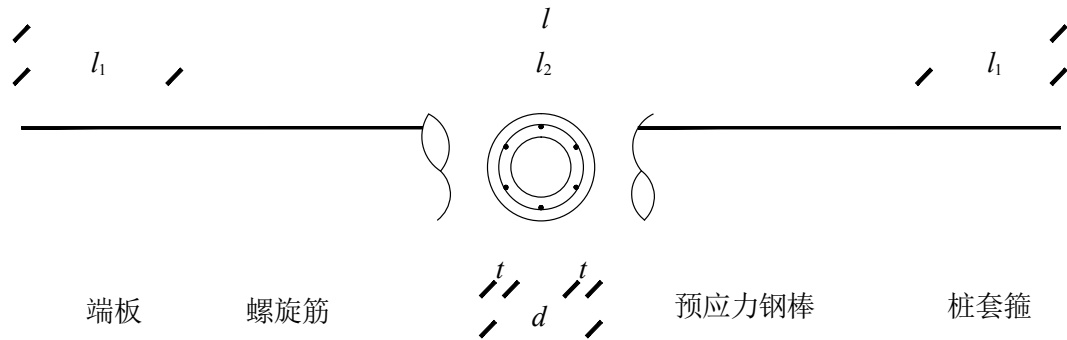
预应力超高强混凝土管桩、预应力高强混凝土管桩、预应力混凝土管桩、预制竖向劲性体管桩结构形式
